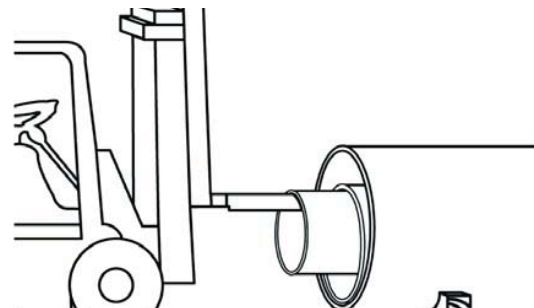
Desembalaje de tubos anidados con ayuda de un montacargas, utilizando un brazo con protección.
